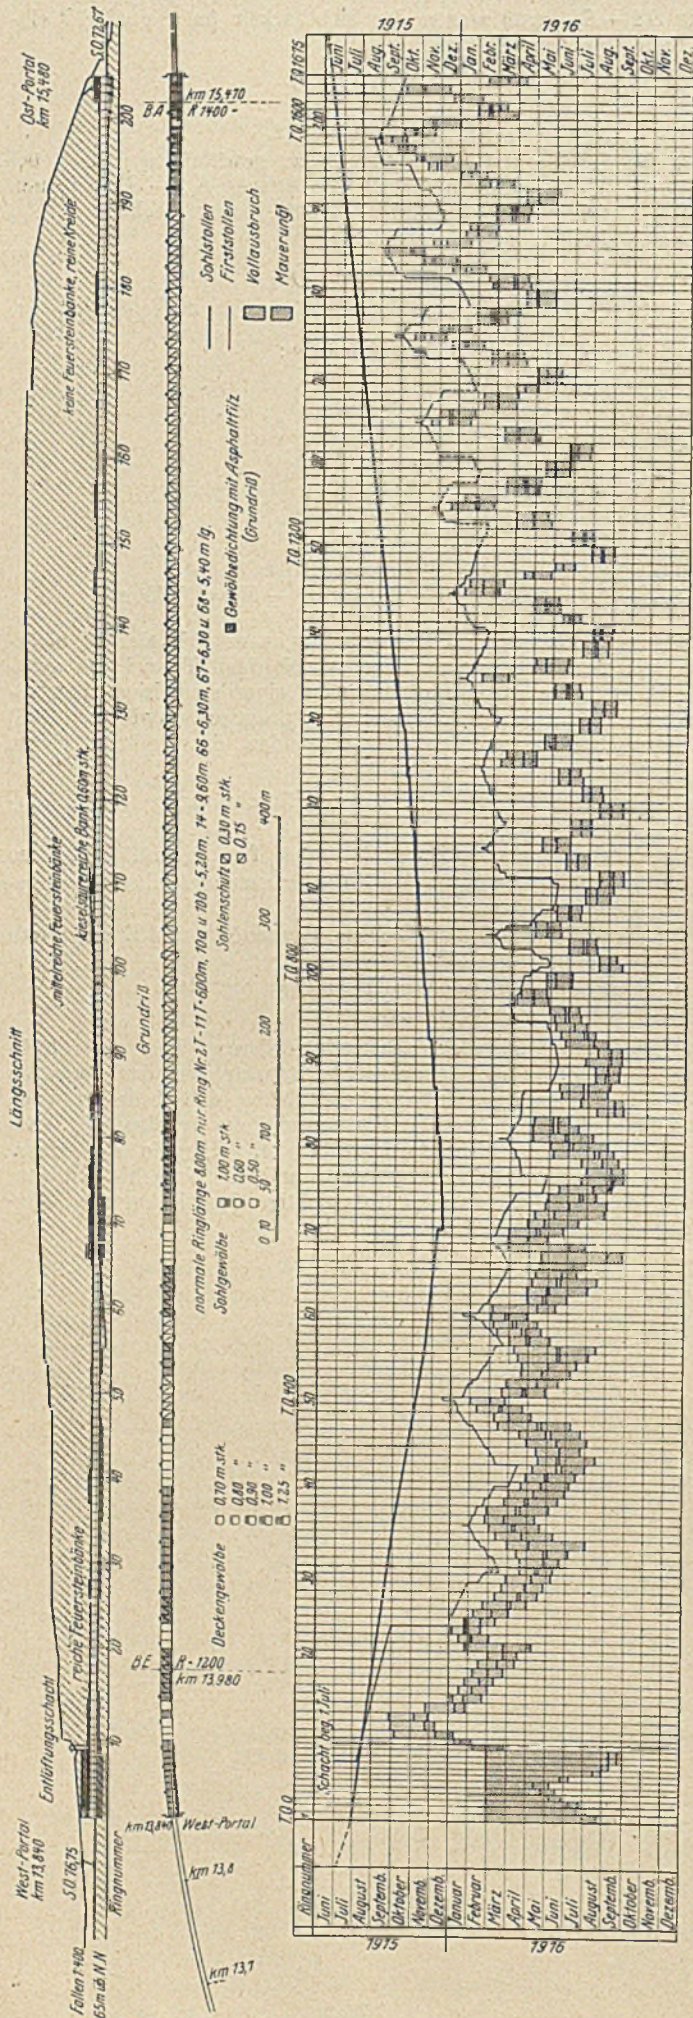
Tunnel-Längsschnitt und Grundriß mit Darstellung der verschiedenen ausgeführten Mauerungsprofile.
